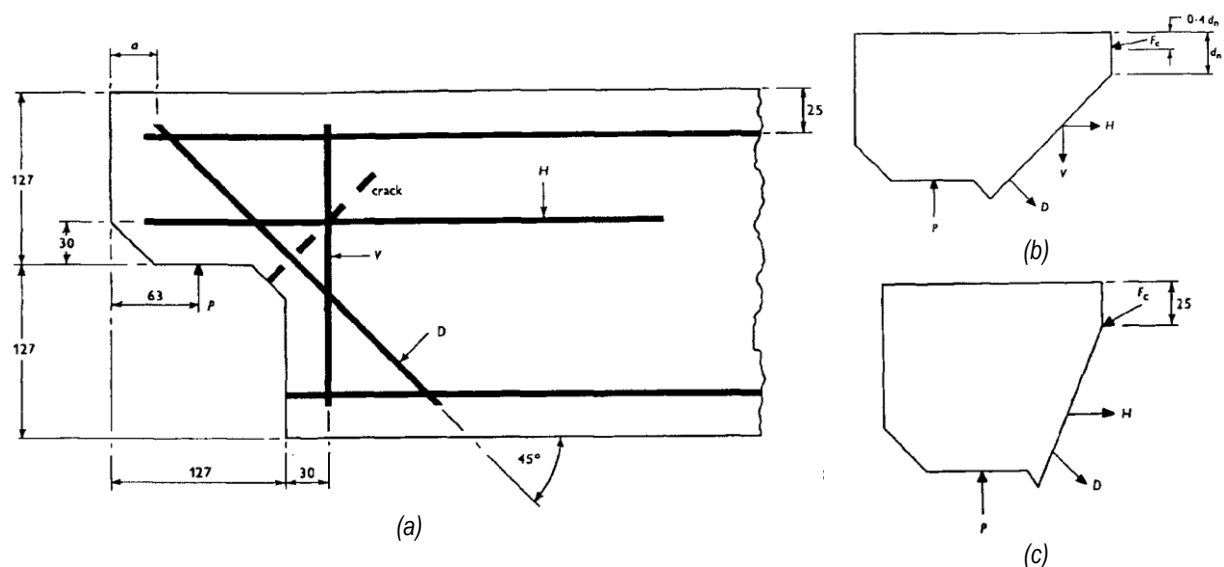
Ensayos de Reynolds [34]: (a) Dimensiones del apoyo y detalles del armado; (b) Esquema de cálculo en rotura presuponiendo fisura a 45° ; (c) Esquema de cálculo en rotura con fisura hacia parte superior del estribo vertical
